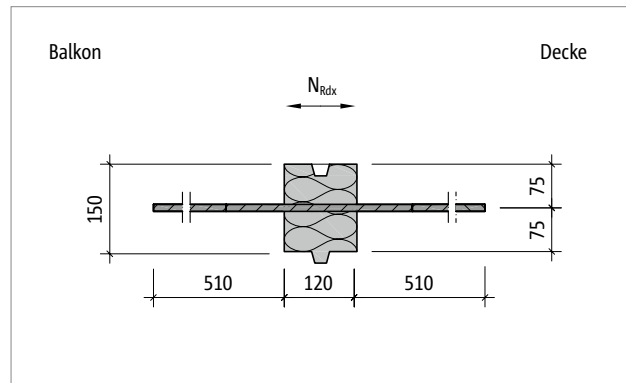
Schöck Isokorb® XT Typ HP-NN2: Produktgrundriss
